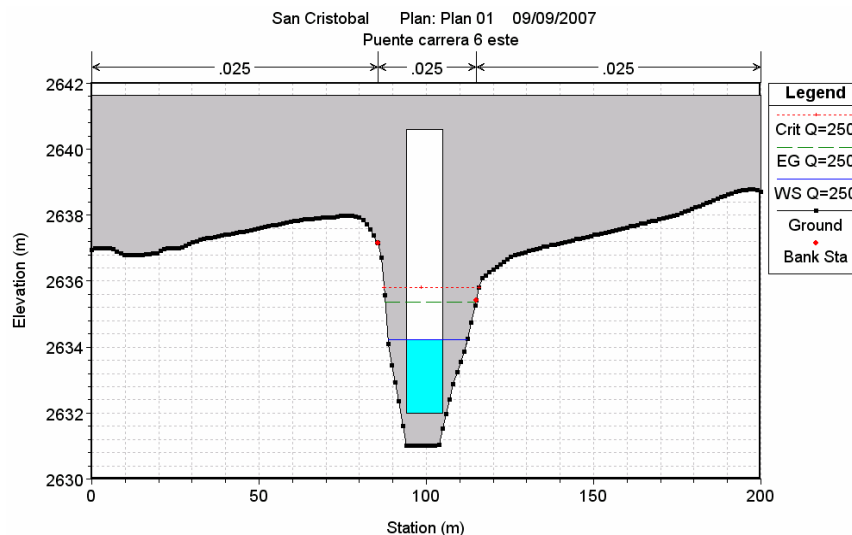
Sección transversal del puente de la carrera 6ª Este
